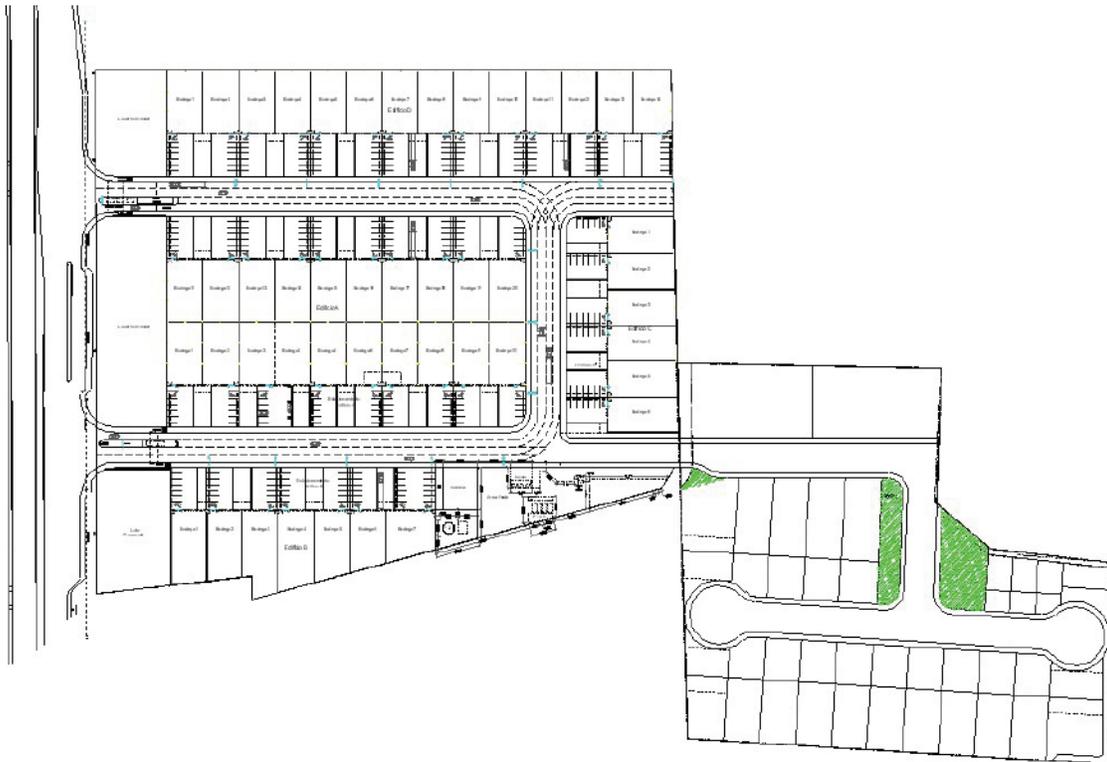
Propuesta de lotificación. Elaboración Propia.
